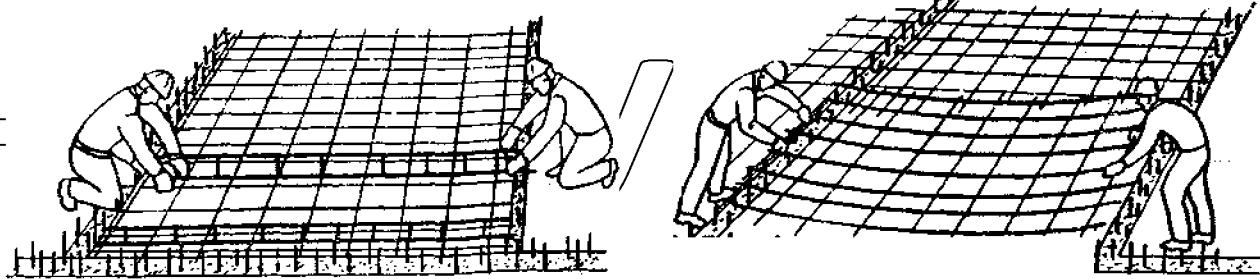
Влаштування арматурних: а)каркасів; б) сіток
